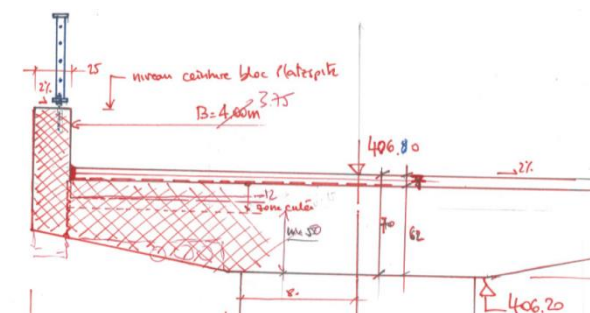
Trögrücke aus Beton – Variante mit Betonbordüre
